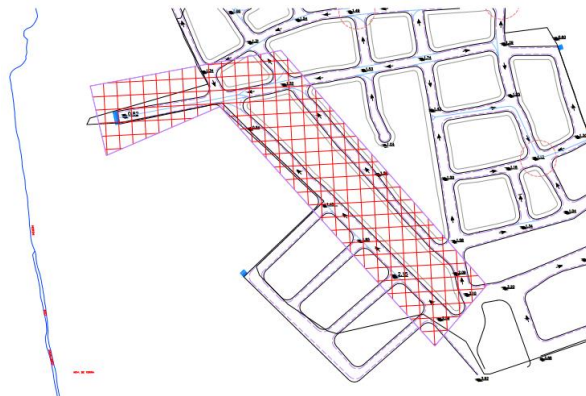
Sub-Bacia 02, trecho mais solicitado Fonte: Planta autoral Autocad.
